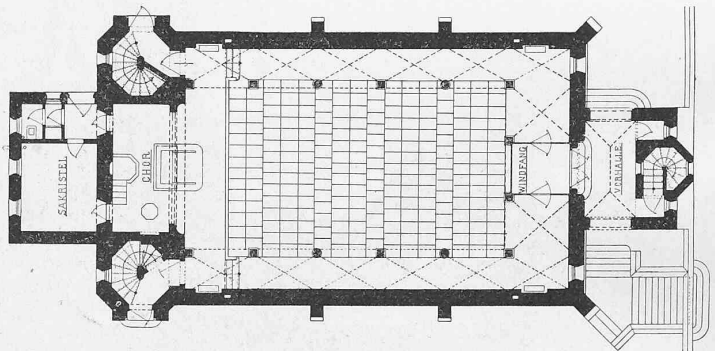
Grundriss der Kirche. — Masstab 1 : 300.
